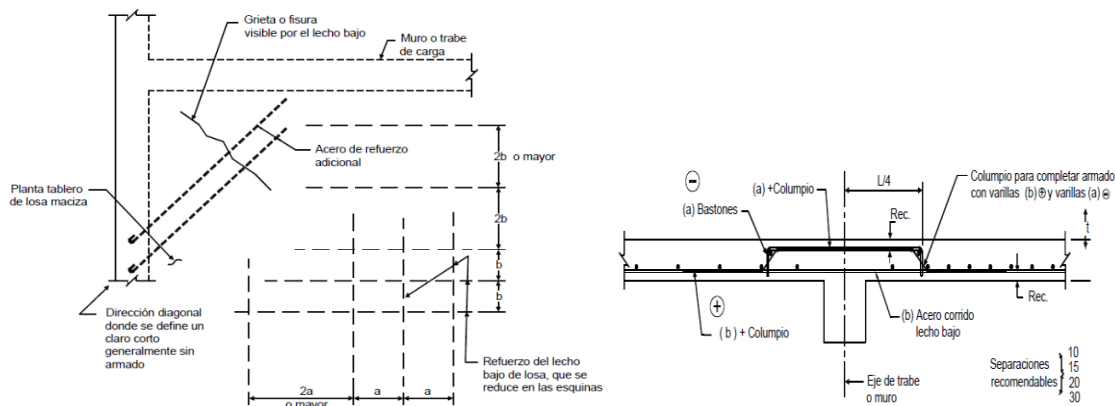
Efecto de esquina en tablero de losa maciza y detalle típico para armado de losa
